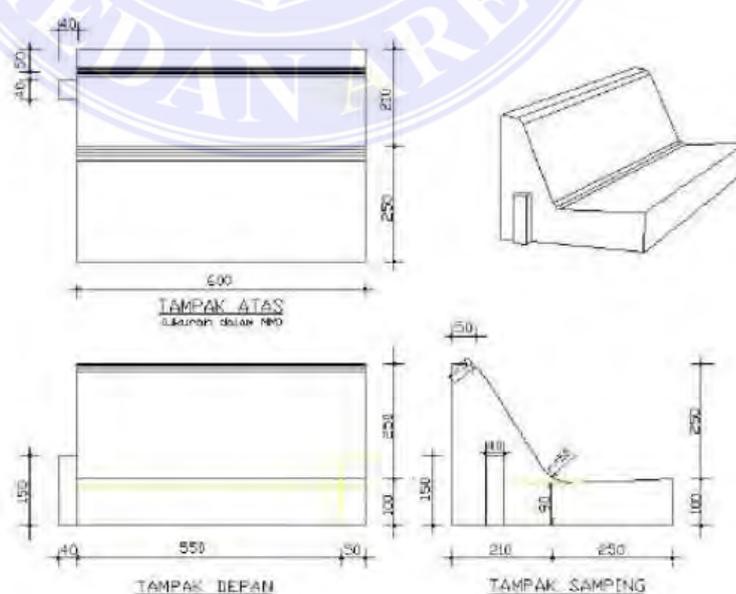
Kerb tegak tanpa komponen horizontal dengan Bukan tipe A2 tipe A2nh (SNI, 2020)
